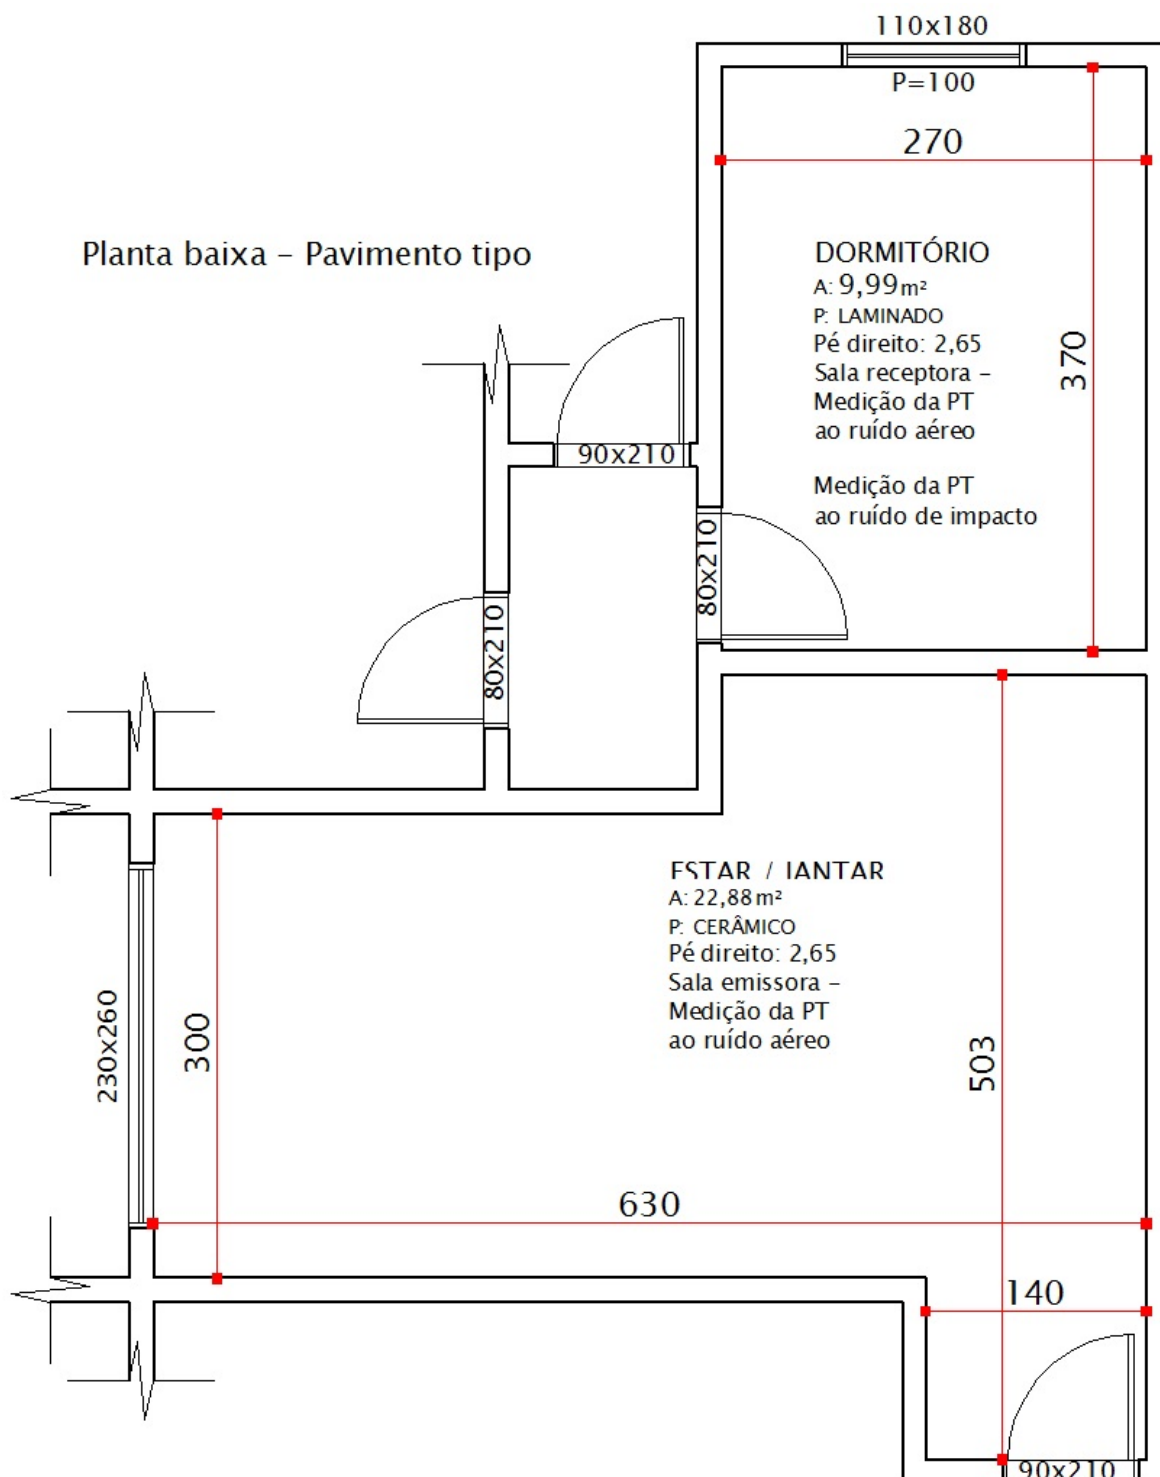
Planta baixa - pavimento tipo - 15-R8-N-BCO-PL
